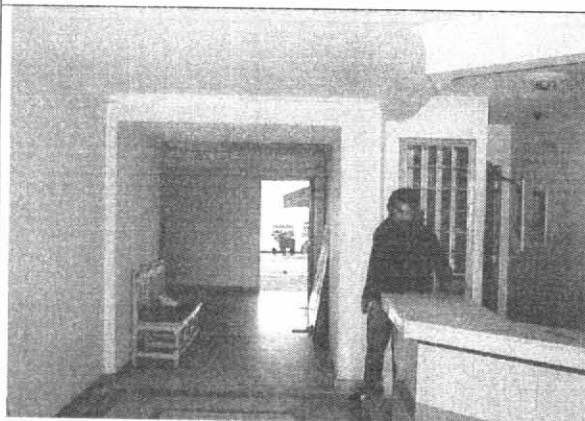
No se evidencian daños estructurales en el sector de acceso al edificio.
